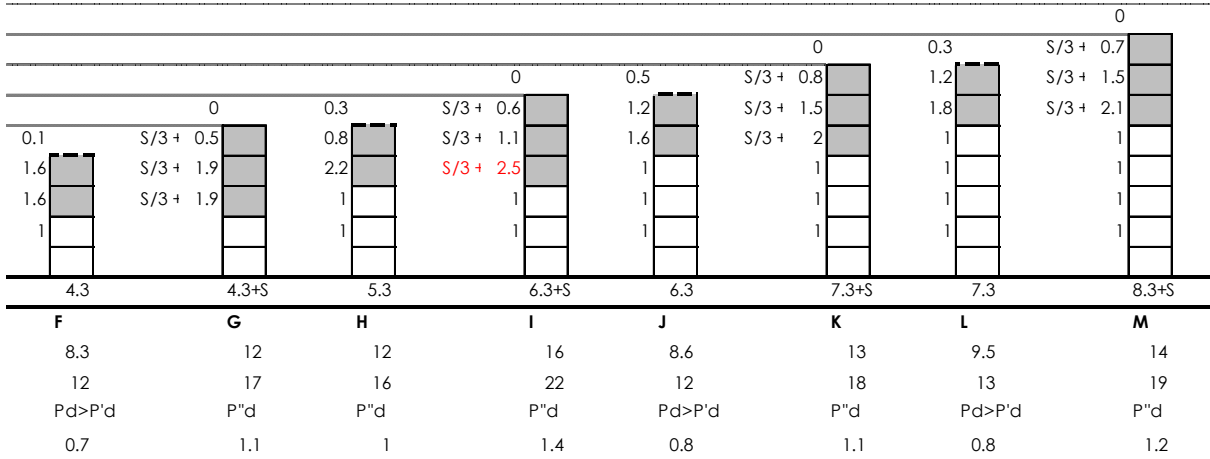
Losa Maciza. Ejecución 3 Cimbras 2/4
